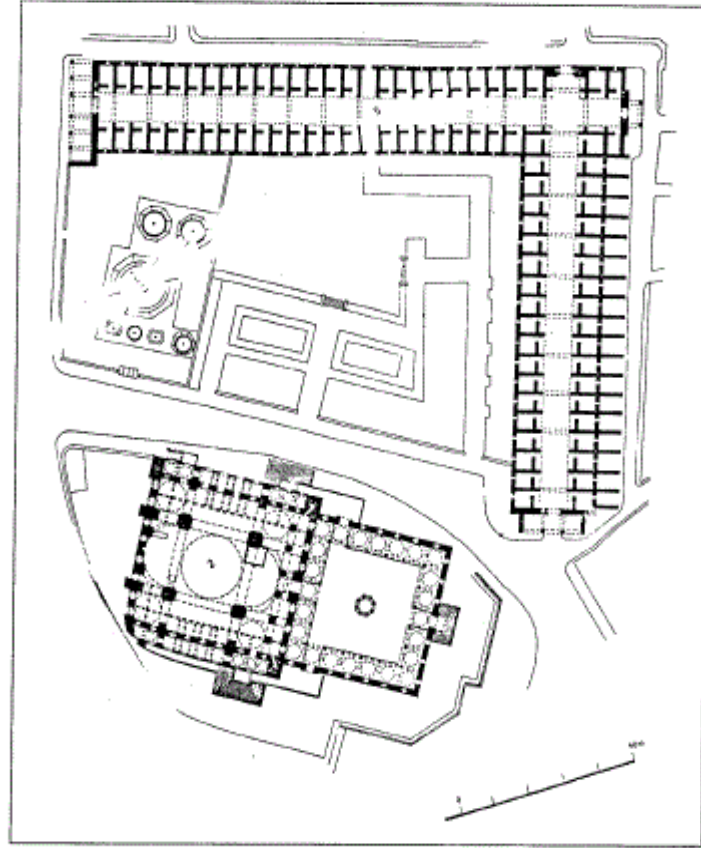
مسقط أفقي لمجمع السلمانية في إستانبول (عن : كوران) .
